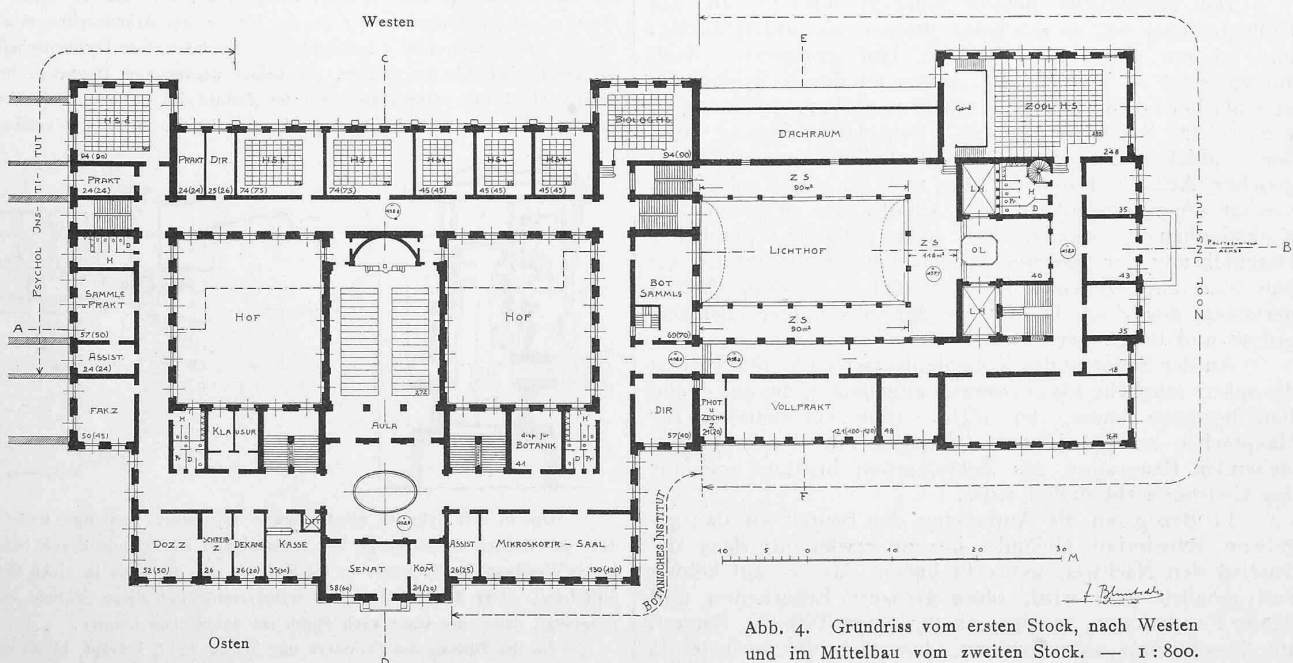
Grundriss vom ersten Stock, nach Westen und im Mittelbau vom zweiten Stock. — 1 : 800.
